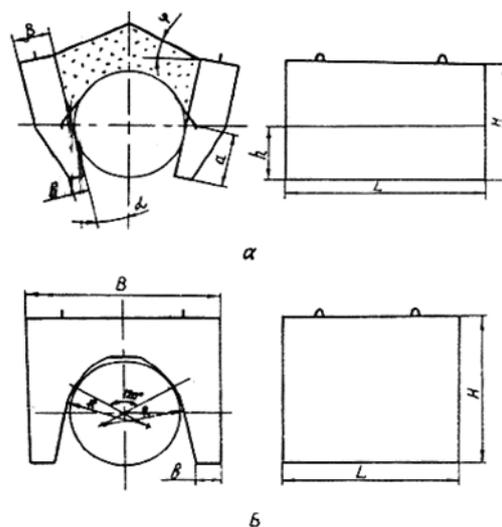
Схемы конструкций железобетонных утяжелителей:
